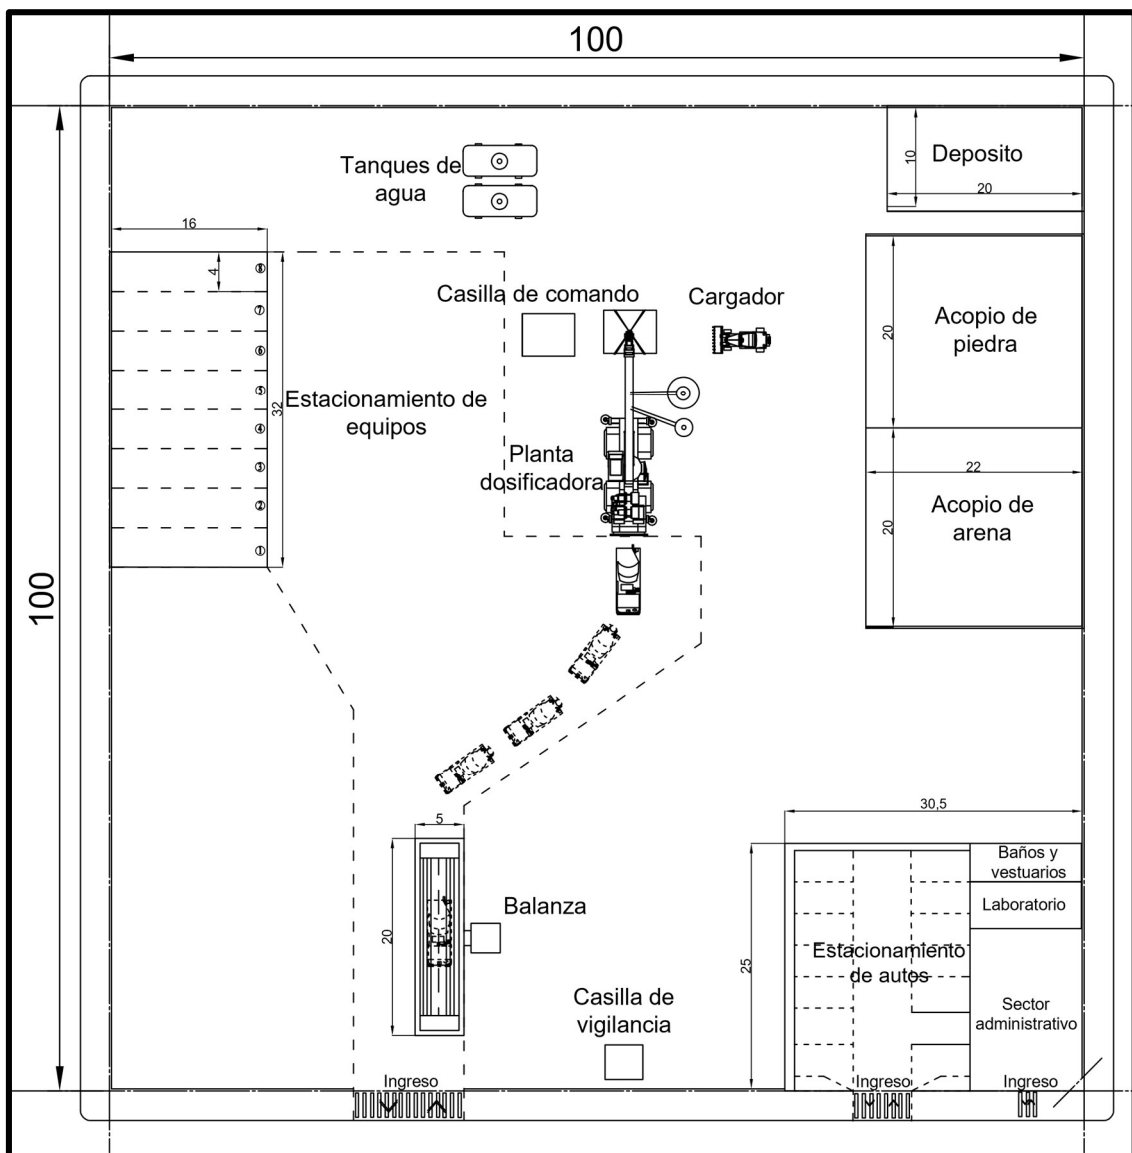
Sectorización del terreno de la planta (fuente: elaboración propia).
